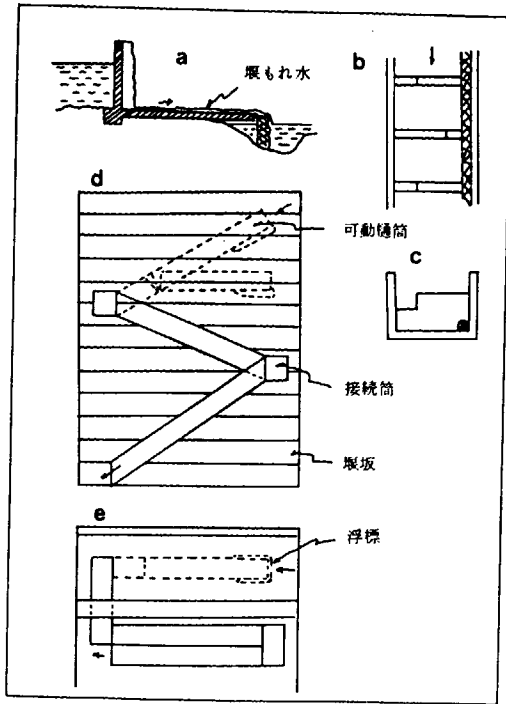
ウナギ魚道の型 (a は縦断面図, b・e は平面図, c は横断面図, d は正面図) (小山, 1967)
